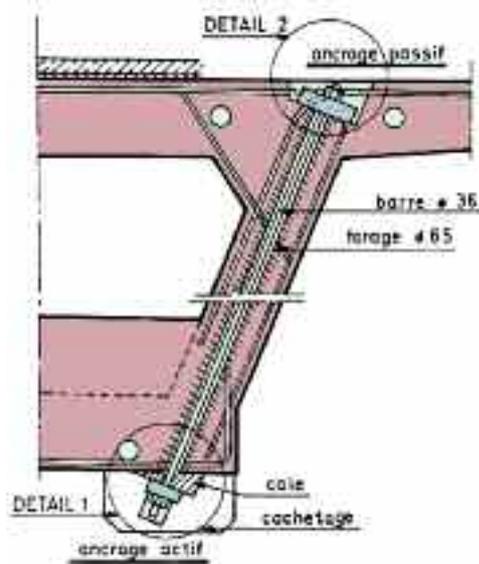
schéma d'un étrier actif interne au béton d'une des âmes d'une poutre-caisson
